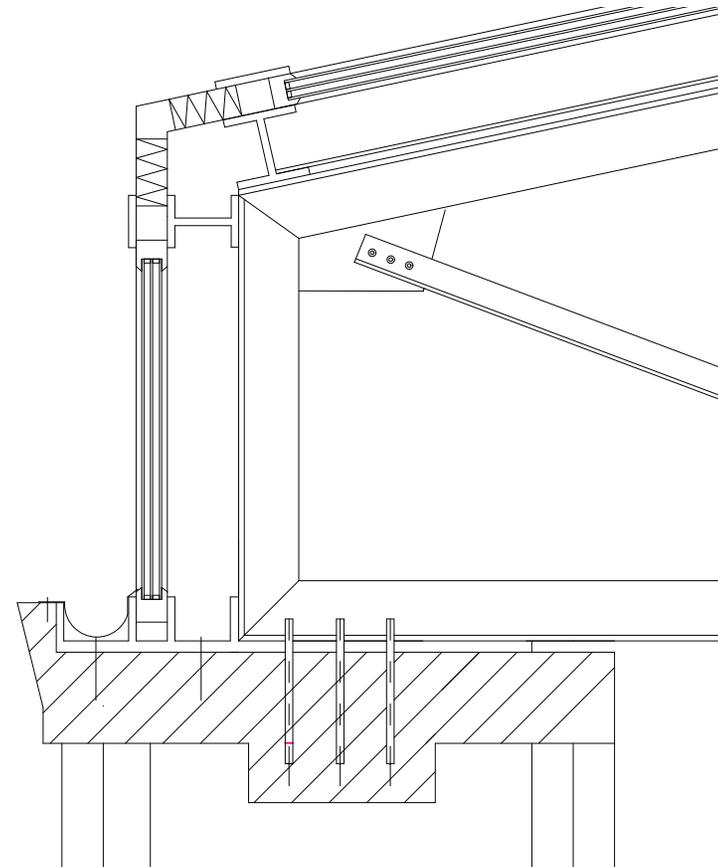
Detail Fachwerk und Anschluss an Bestandsmauer 1:20
